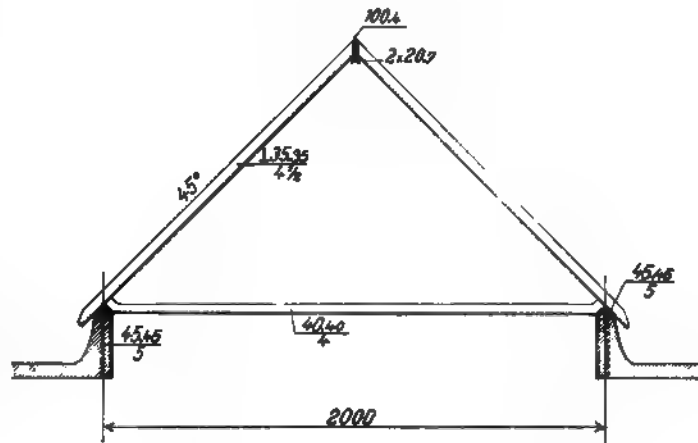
Oberlichtkonstruktion der Glanzstoffabrik St. Pölten.
